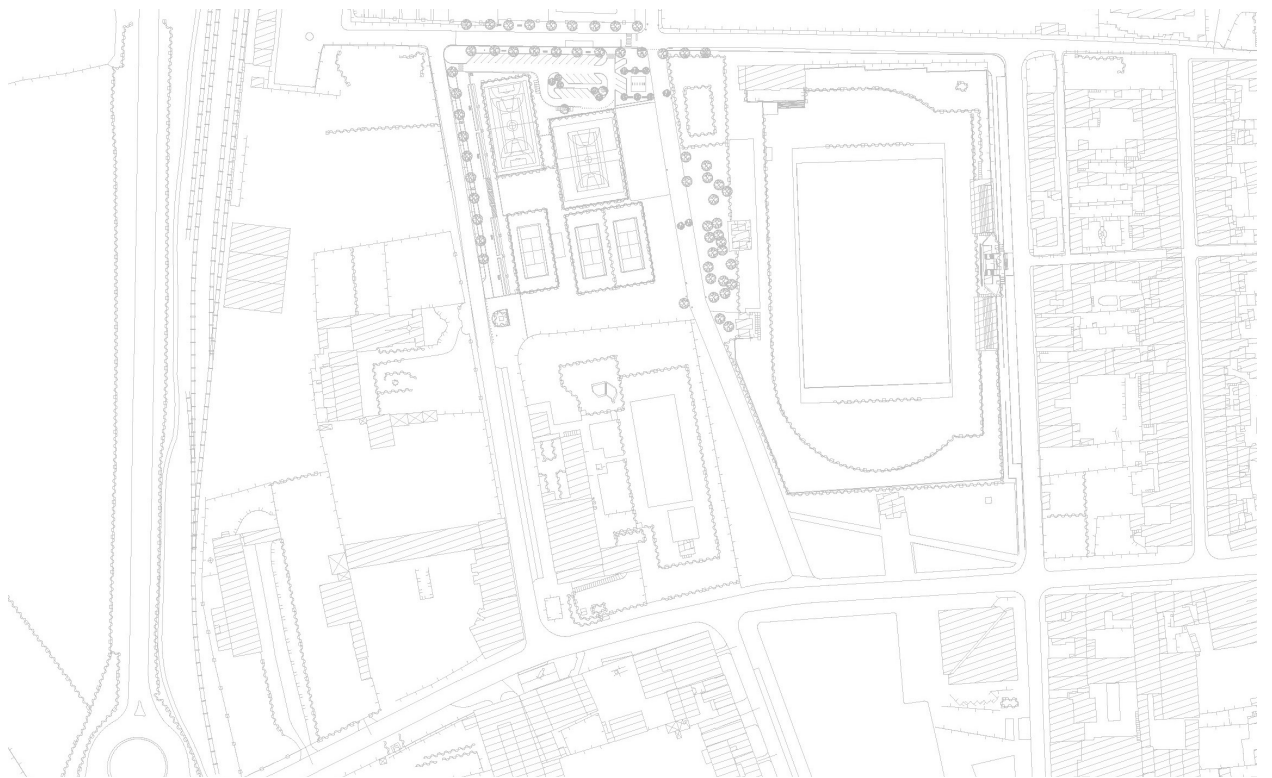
Planta da Situação Atual da Zona de Intervenção
